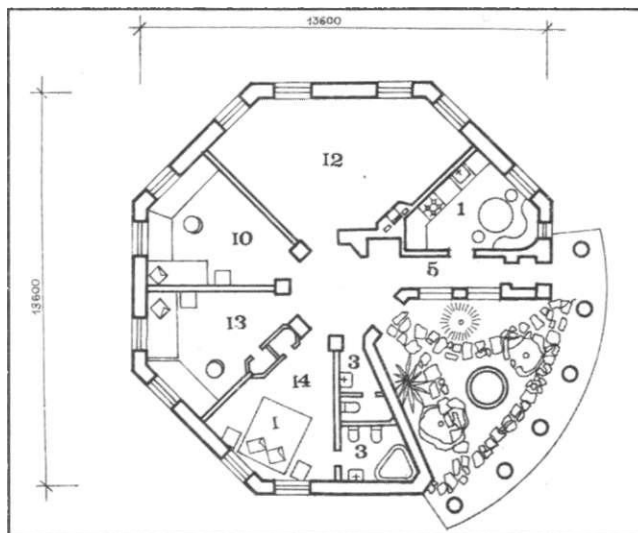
План першого поверху жилої будівлі з внутрішнім двориком
